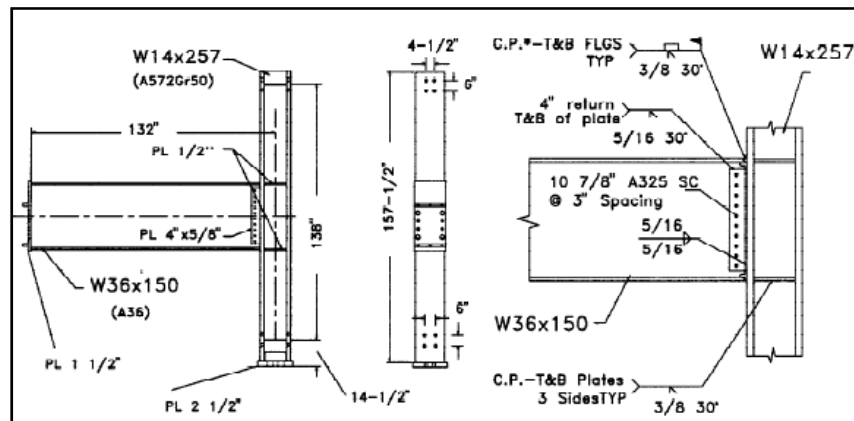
Detalle del espécimen – Prueba 2 (Povov y Blondet, 1996)
